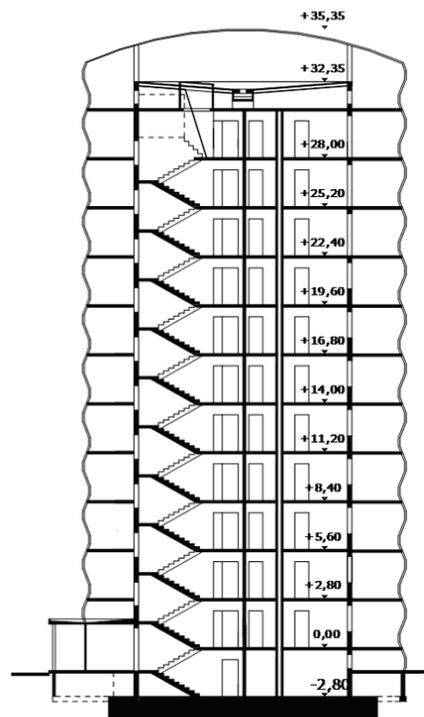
Schnitt mit neuer Stahlkonstruktion M=1:500
